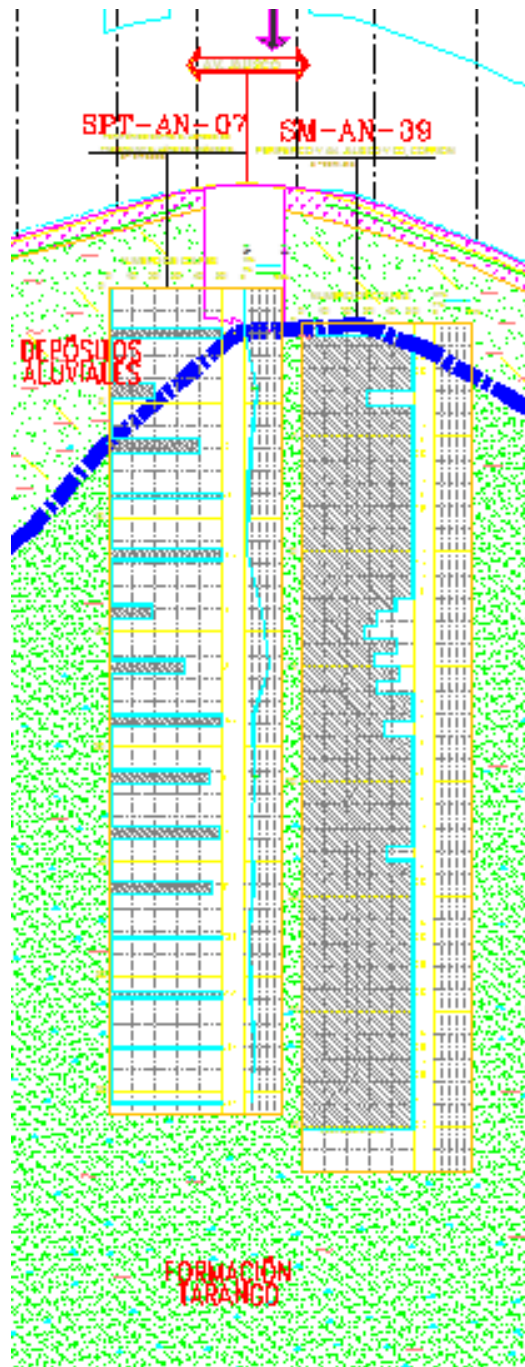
Estratigrafía. Pilas en Zona Minada- Zona I
